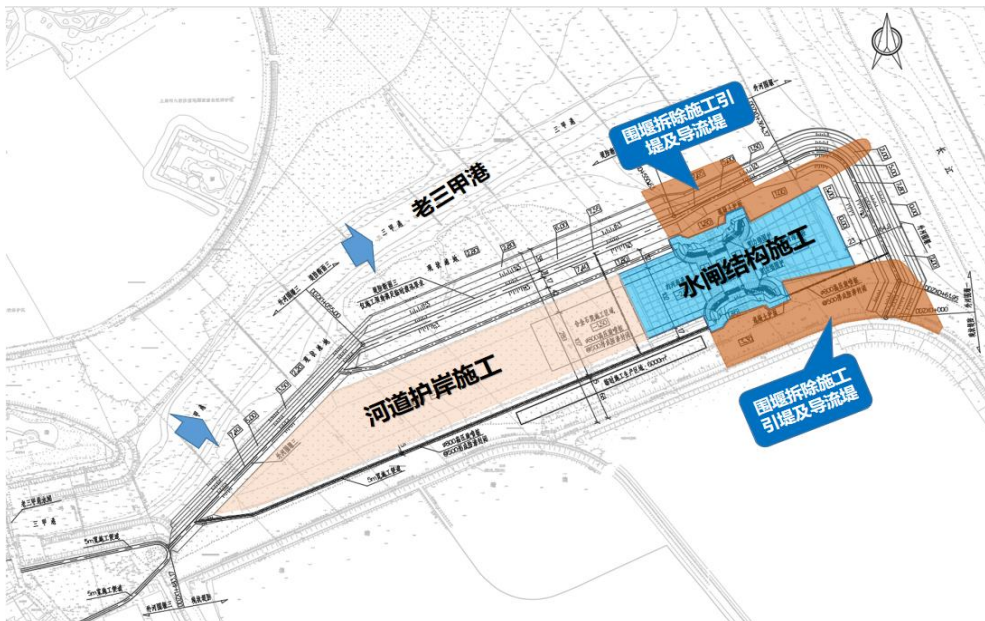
一阶段(2025年5月1日至2026年7月31日)施工布置示意图
